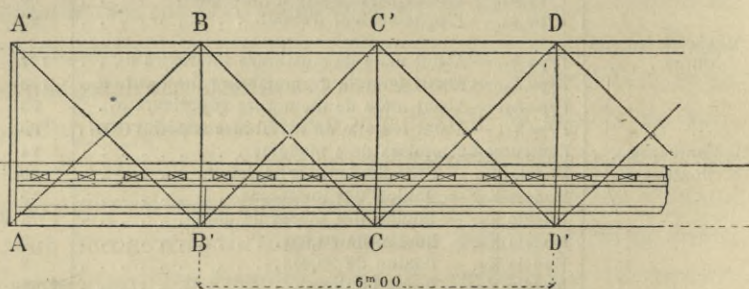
Schéma de la poutre principale du pont de 33 mètres (type n° 1).
